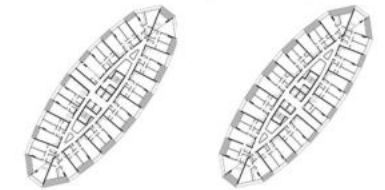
Grundrisse Wohngeschoss (Artec Architekten)
